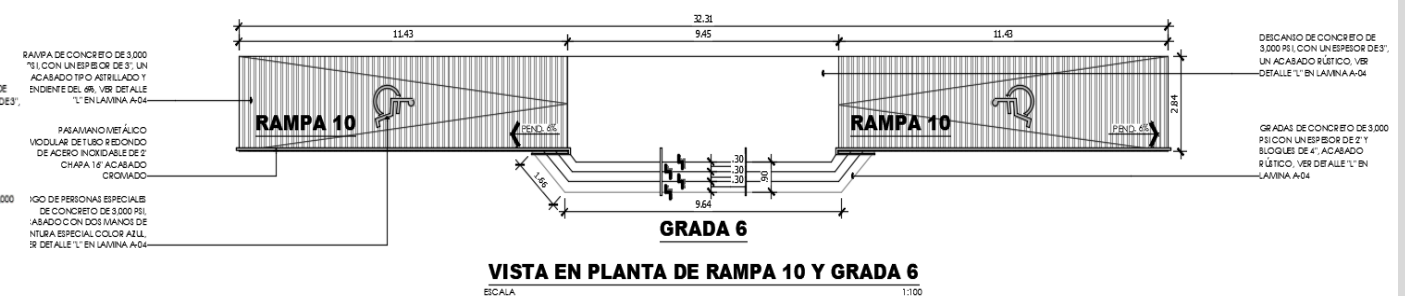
Planta de rampas y grada de acceso a Coliseo, costado Sur. Ver lámina en anexo N°6.
